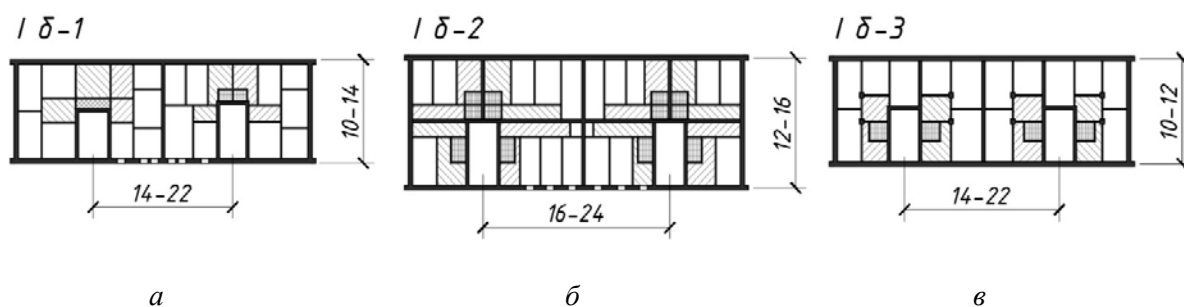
Планировка зданий, подлежащих реконструкции:
